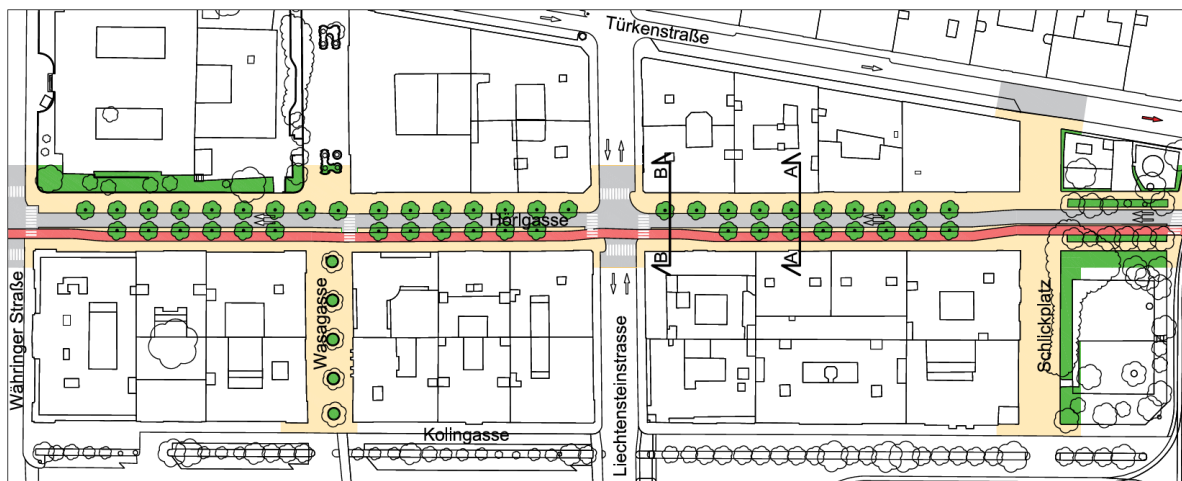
Grundriss Variante 1 (Zweirichtungsradweg)
